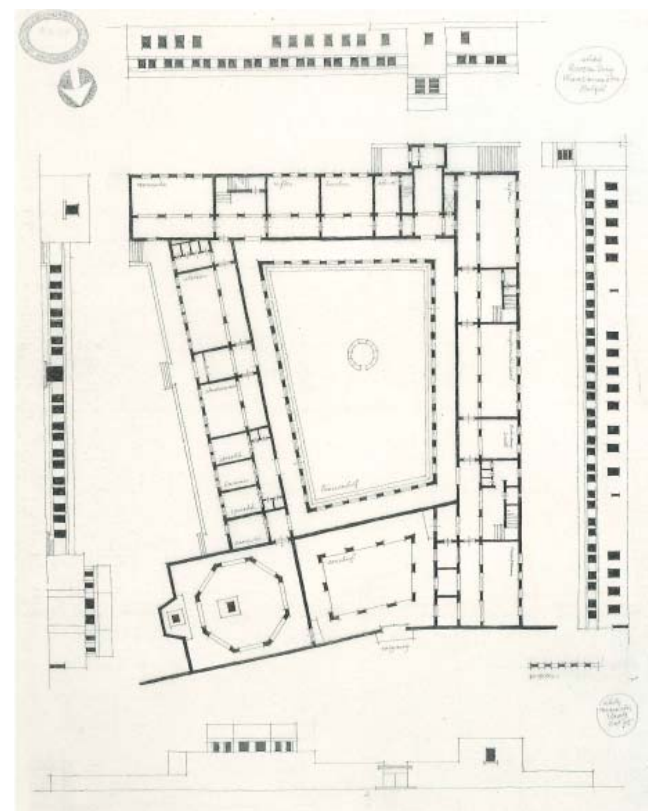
Pianta del piano terra e prospetti esterni del convento di Roosenberg
